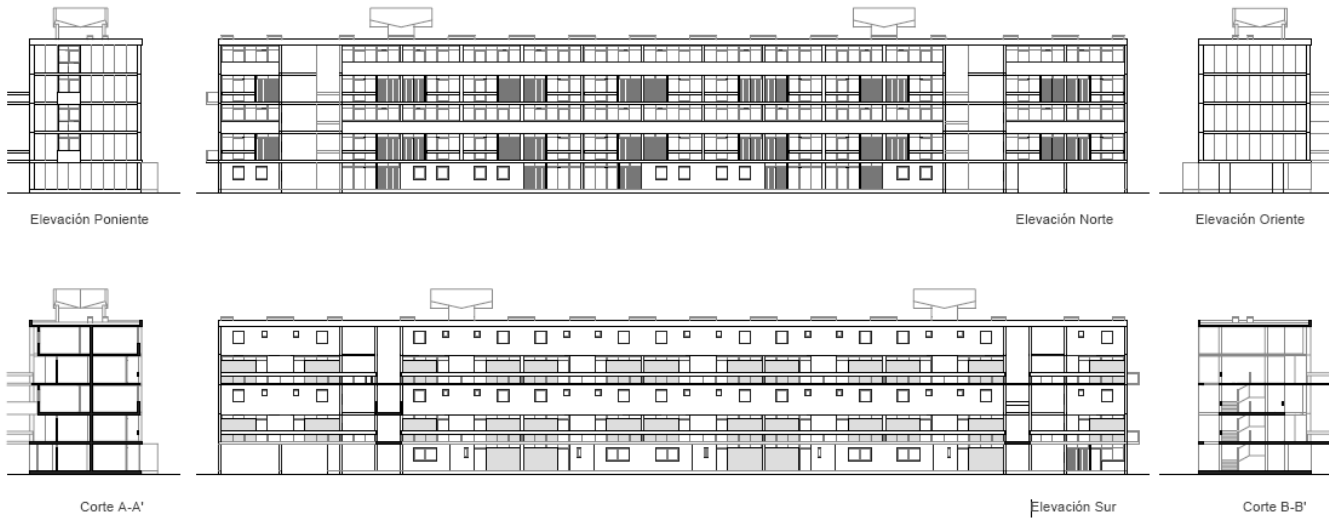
fachada longitudinal bloque dúplex exterior. Fuente: Becerra (2016)
